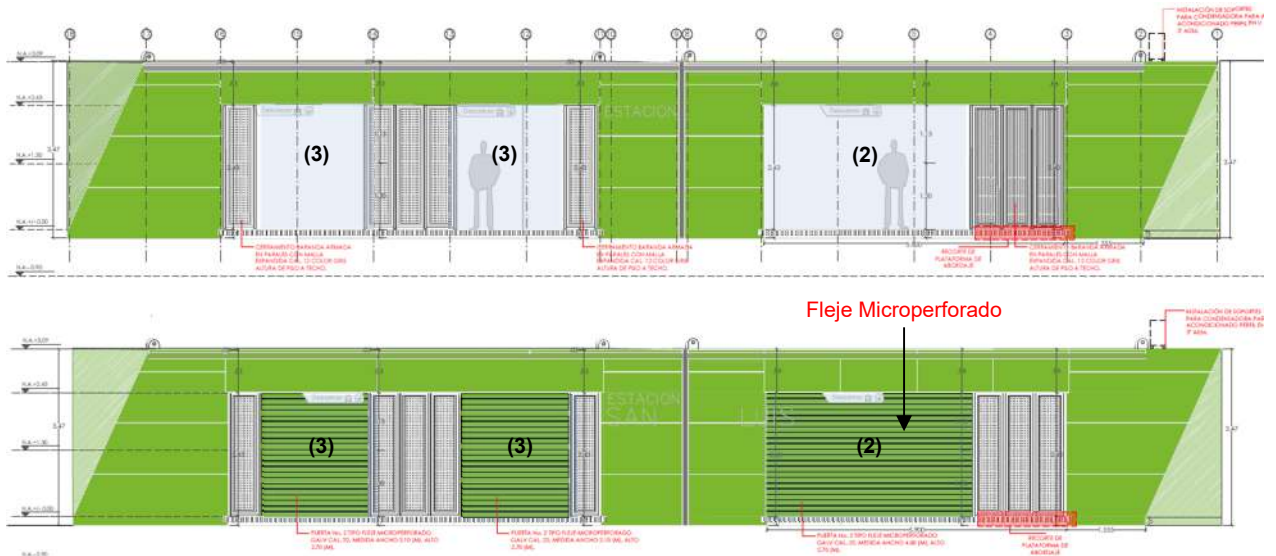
Ubicación puertas vagón acceso zona abordaje. Revisar plano 8. A-201 FACHADA GENERAL 1-2.dwg y 9.A-201A FACH GEN 1-2-cerrada.dwg
